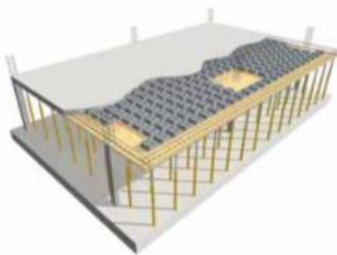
Облегченное перекрытие с применением U-Boot Beton
